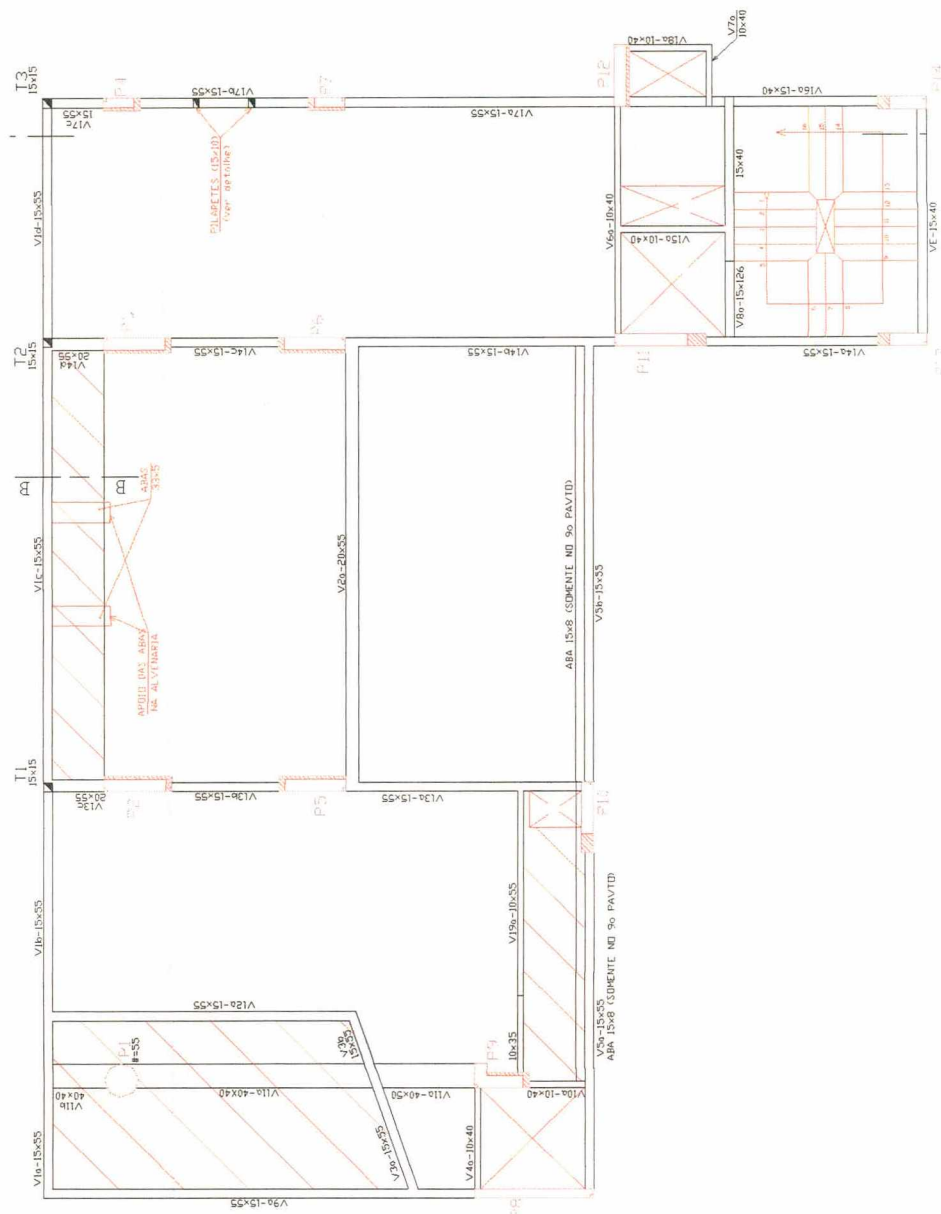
Planta de fôrma do edifício 15FNT1
